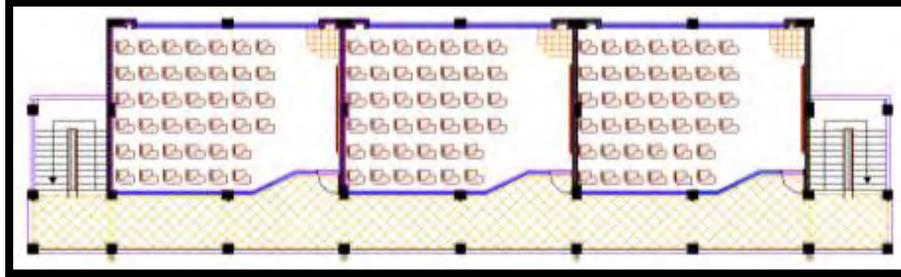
Planta segundo piso bloque de aulas a, b y c
